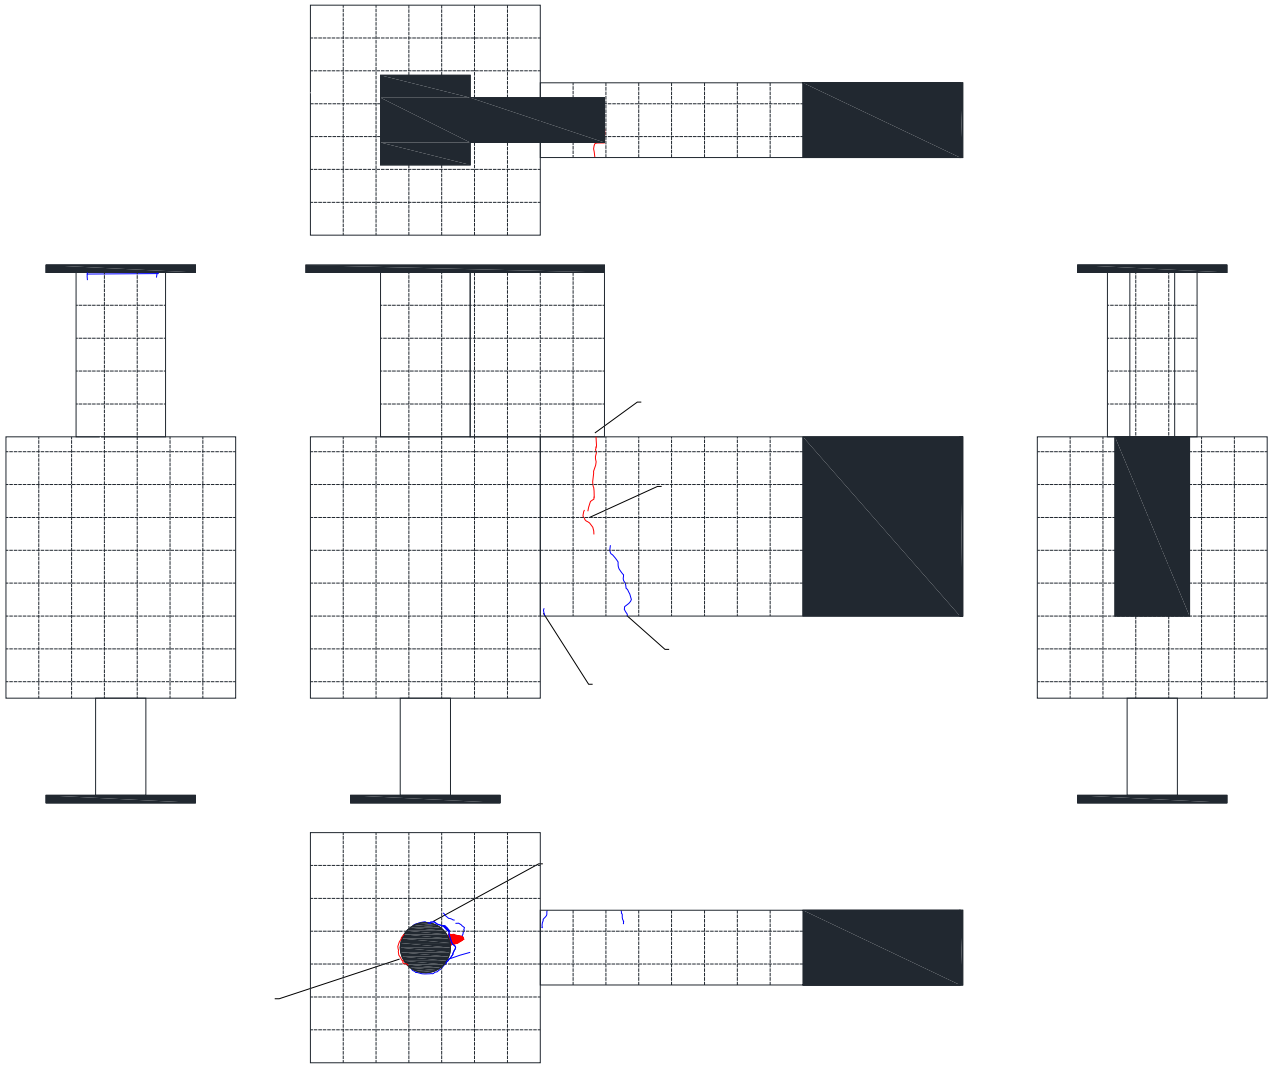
3. 4-7 ひび割れ状況 (R=±2. 0%サイクル①)
